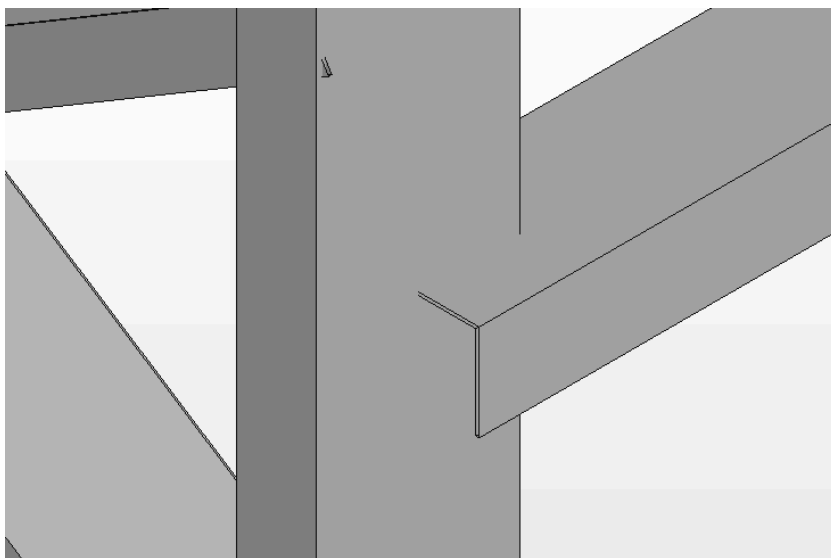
Vista tridimensional da ligação pilar | madre de fachada no Robot Structural Analysis 2020
